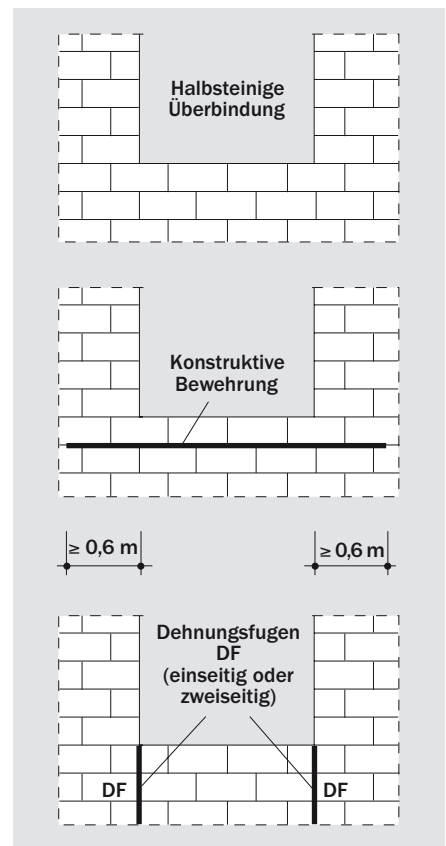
Brüstungsbereiche; Rissvermeidung bei Verblendschalen
